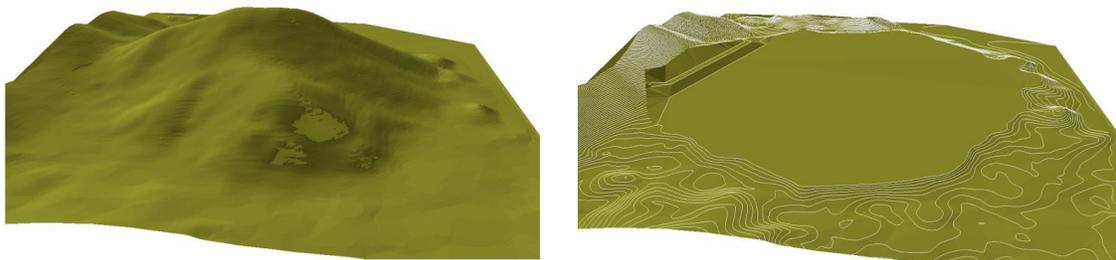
Ilustración No.II.15. Vistas 3D de la topografía actual y final del sitio
